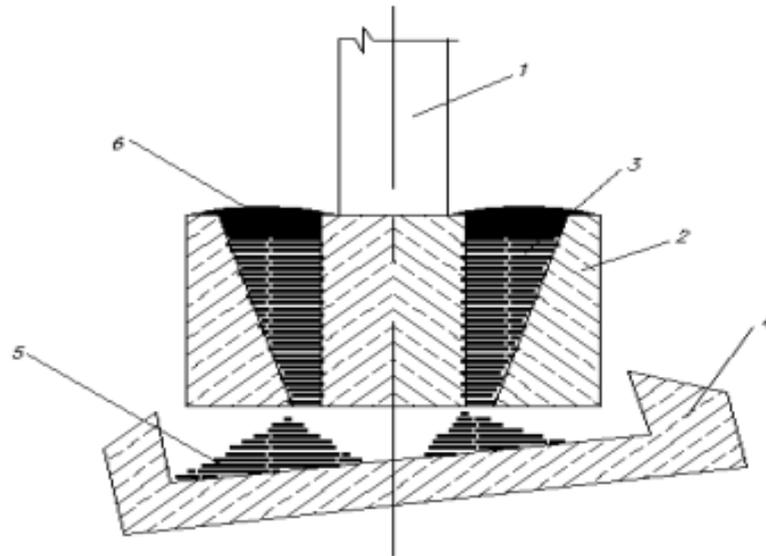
Фундамент, що забезпечує збереження будівель та споруд при нерівномірних осадах: 1 – стіна, 2 – нерозрізний пояс, 3 – наскрізні вертикальні отвори, 4 – фундаментні блоки, 5 – сипуча речовина, 6 – знімна кришка
